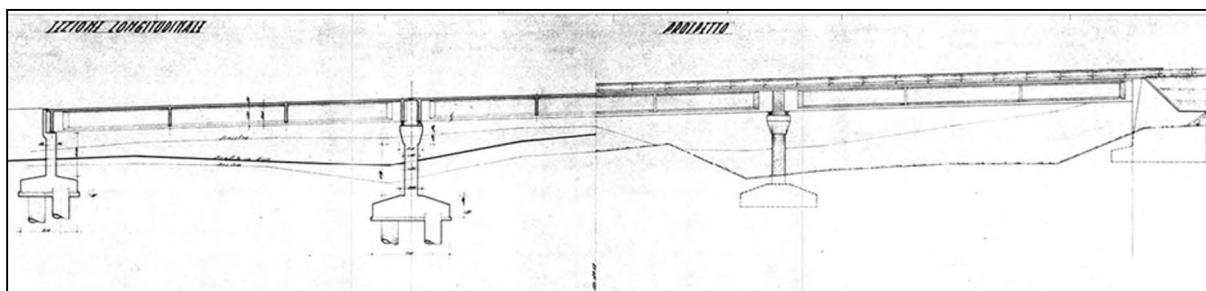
Prospetto e sezione longitudinale – contabilità originale
